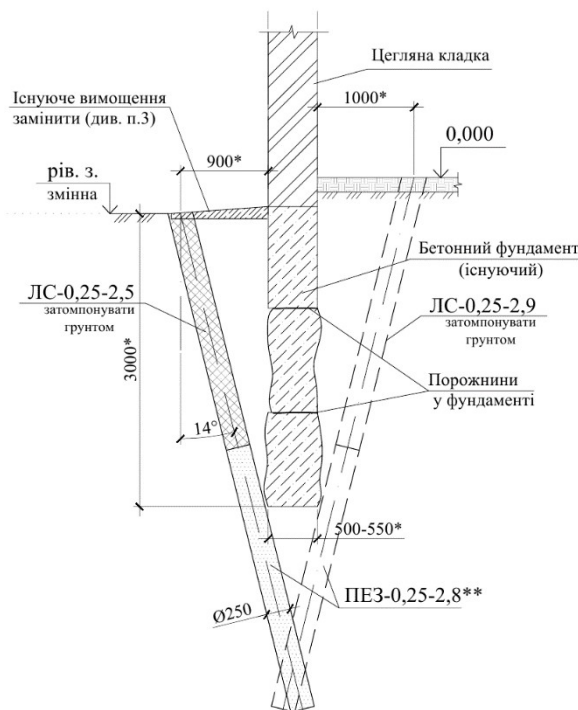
Схема використання похилих ґрунтоцементних елементів для зміцнення основи існуючого фундаменту
